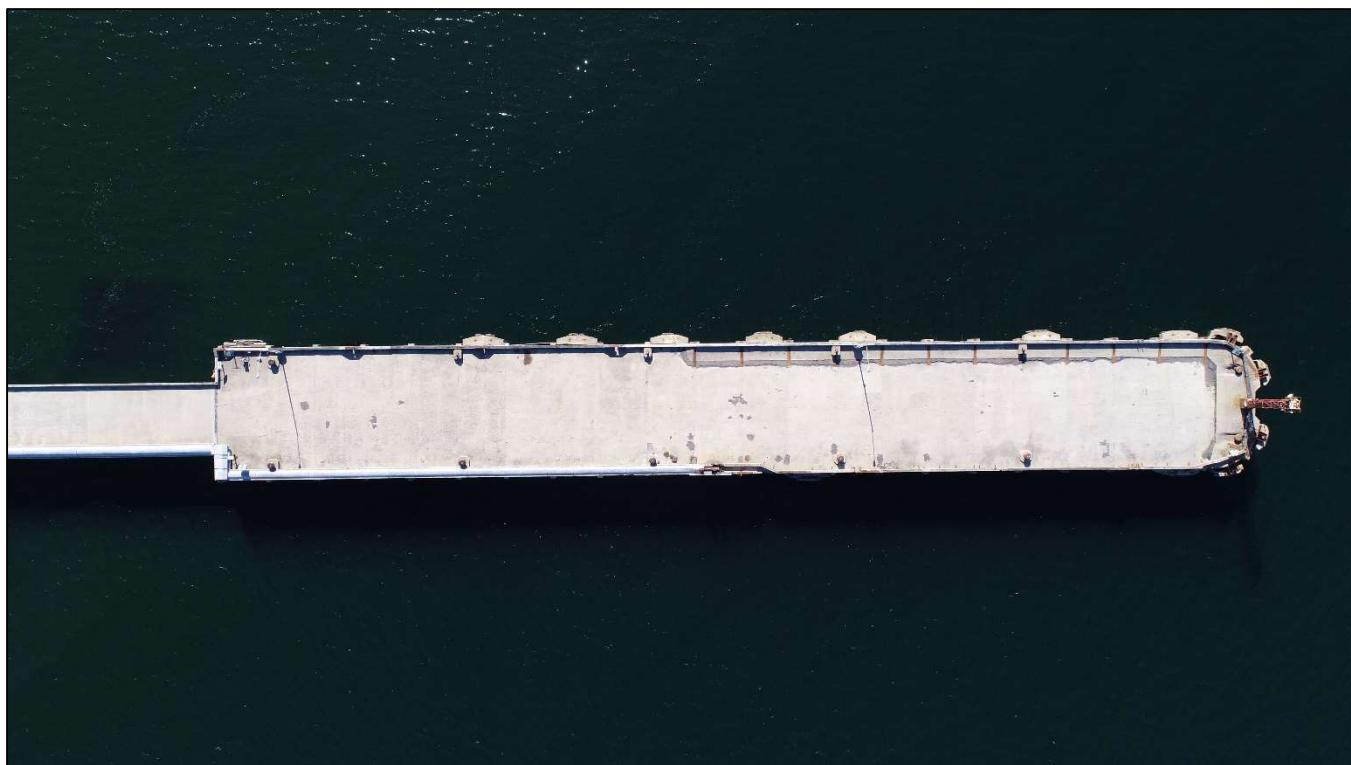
VUE EN PLAN DE LA SECTION DE TÊTE DU QUAI DU CAP NOIR
